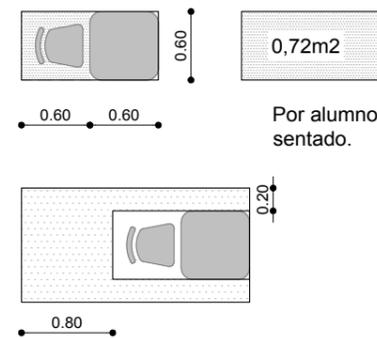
Esquema en planta de un puesto de trabajo en aula.
